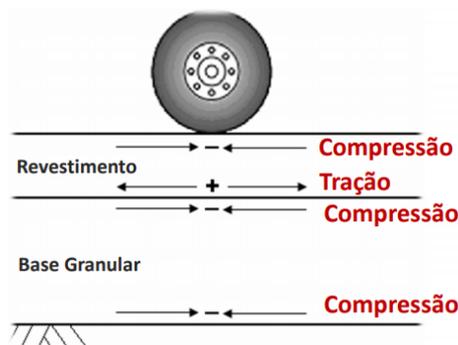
Análise de tensões e deformações em camadas do pavimento
